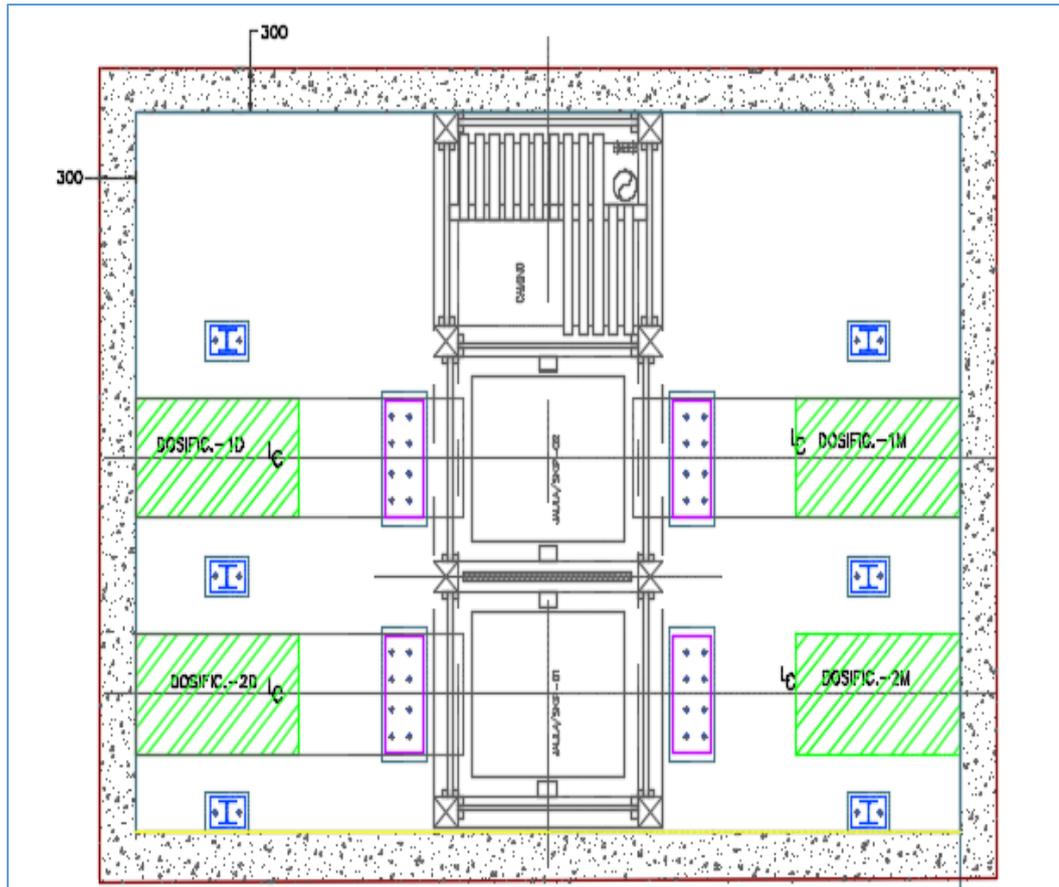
Vista en planta de la instalación de los dosificadores, 2 en cada lado
